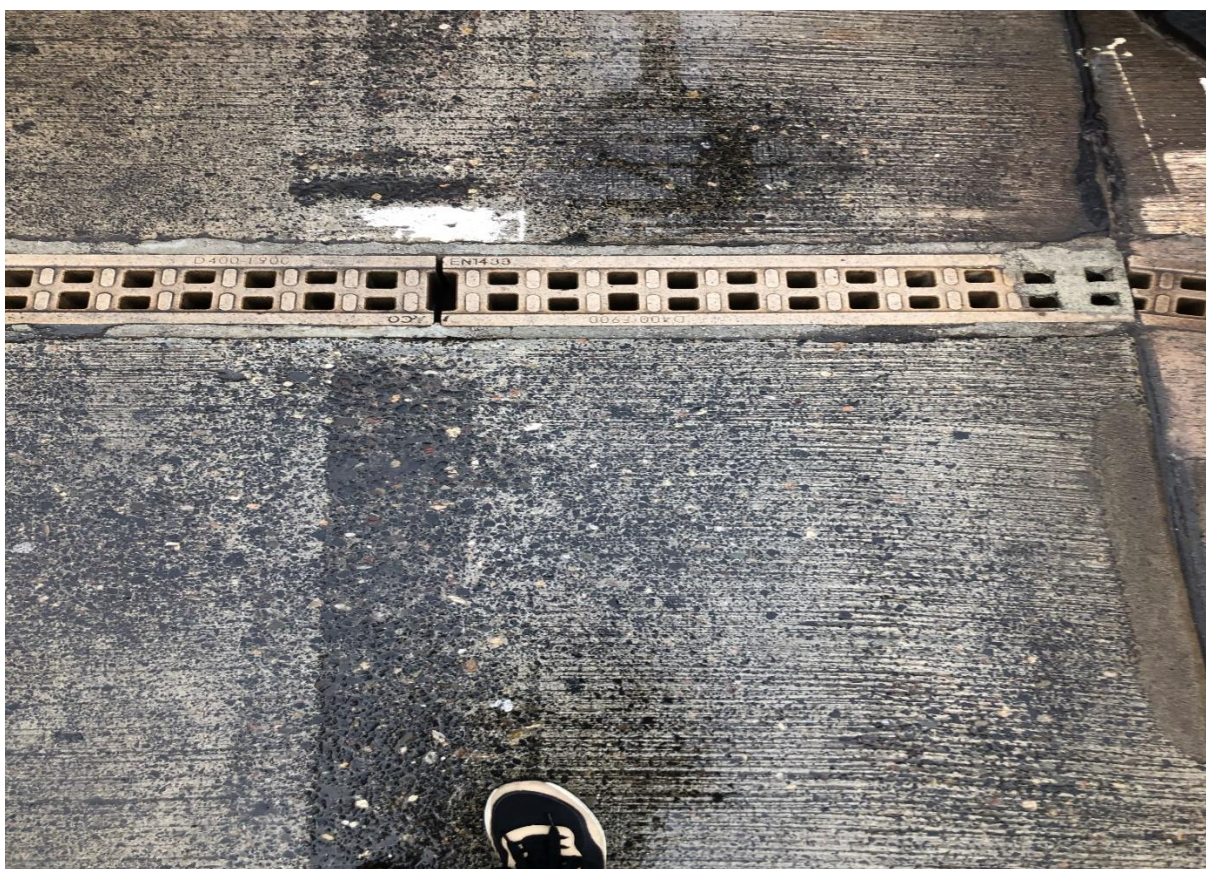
Wyżłobienia w powierzchni betonu w śladach przejazdu kół
